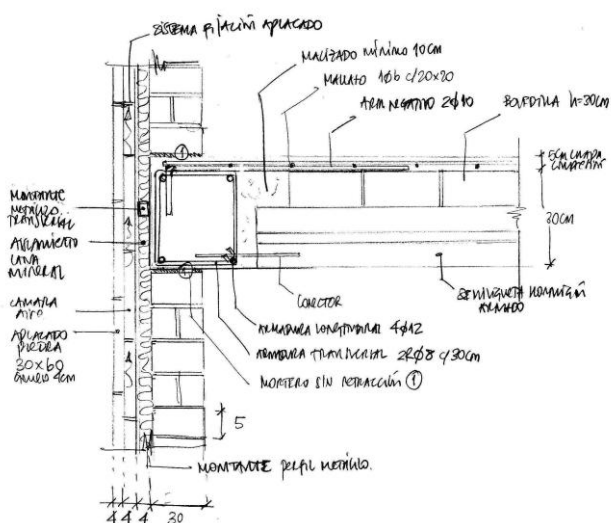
y Fig 3. Detalle: "Encuentro de forjado unidireccional con fachada ventilada" Bloque 1 Proyectos Técnicos I. 2012. EPSEB
